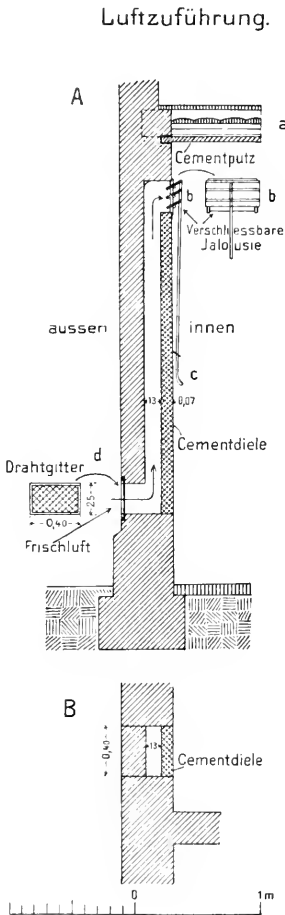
A Luftzufuhr durch die Ringmauer, a Lufteintritt aussen über dem Erdboden, Öffnung durch ein Drahtgitter verschlossen, b b verschliessbare Jalousie, durch den Stab c regulierbar. a Stalldecke. B Grundriss. (Kühn-Dresden.)
